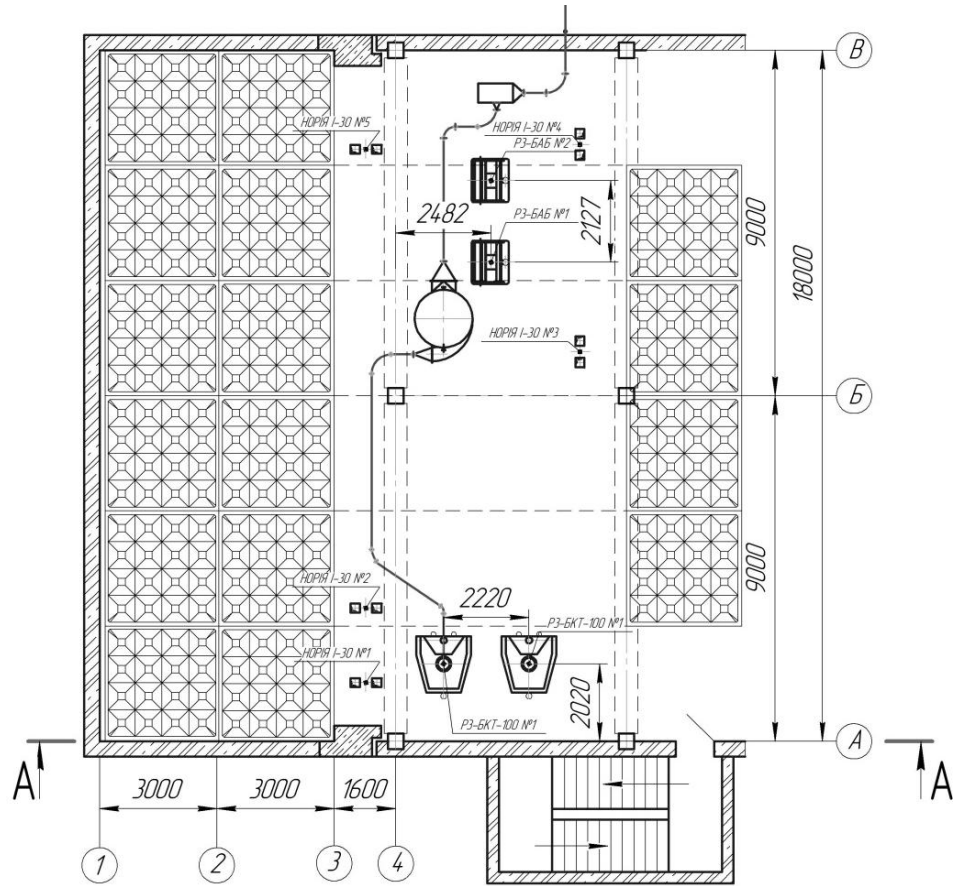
План другого поверху цеху з обробки насіння сої
